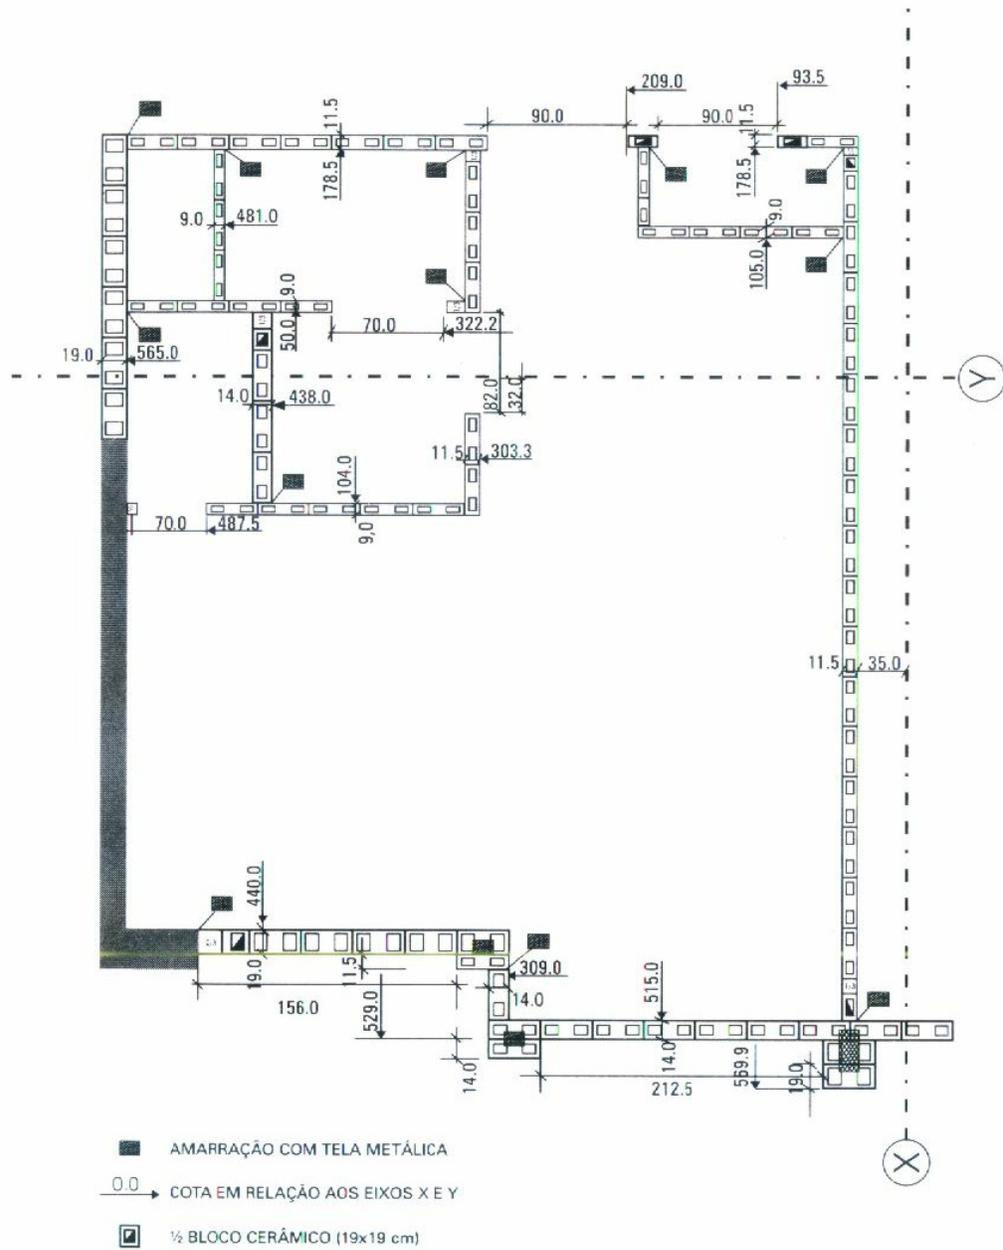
Exemplo de planta de locação da primeira fiada de alvenaria.
